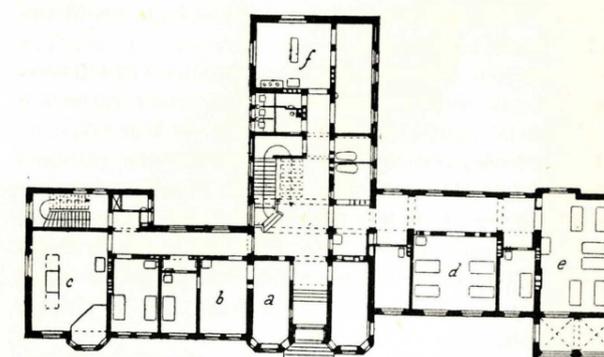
Ospedaletto di Eberswalde (Pianterreno).
